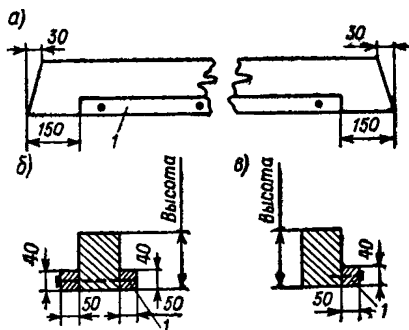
Балки деревянные с черепными брусками для перекрытий а — общий вид; б, в — поперечные сечения балок типа БД и БО (размеры в мм); 1 — крепление брусков к балке
